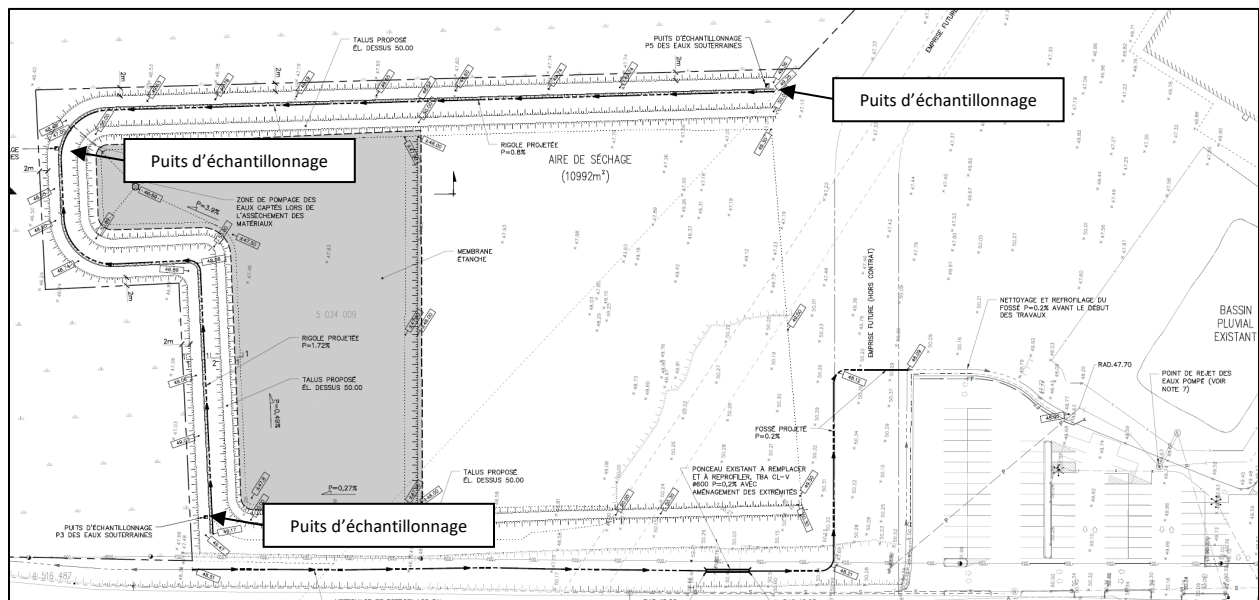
PLAN DE CONCEPTION PRÉLIMINAIRE DU BASSIN D'ASSÈCHEMENT P3
